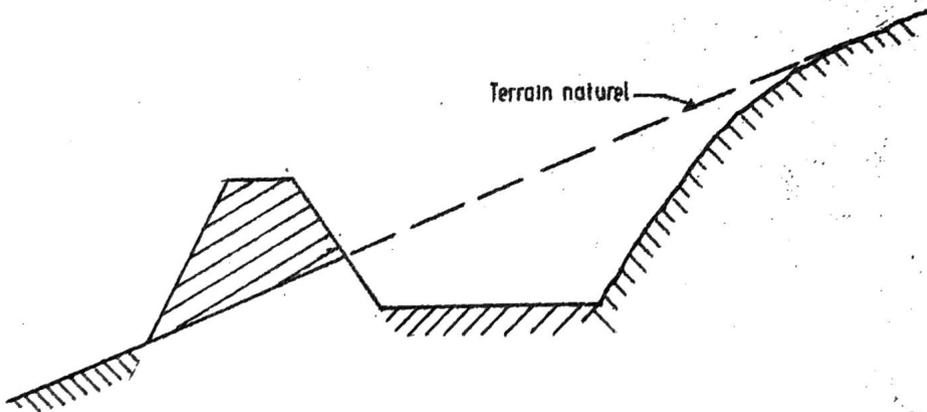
Schema d'une section transversale d'un fosse à flanc de coteaux.
